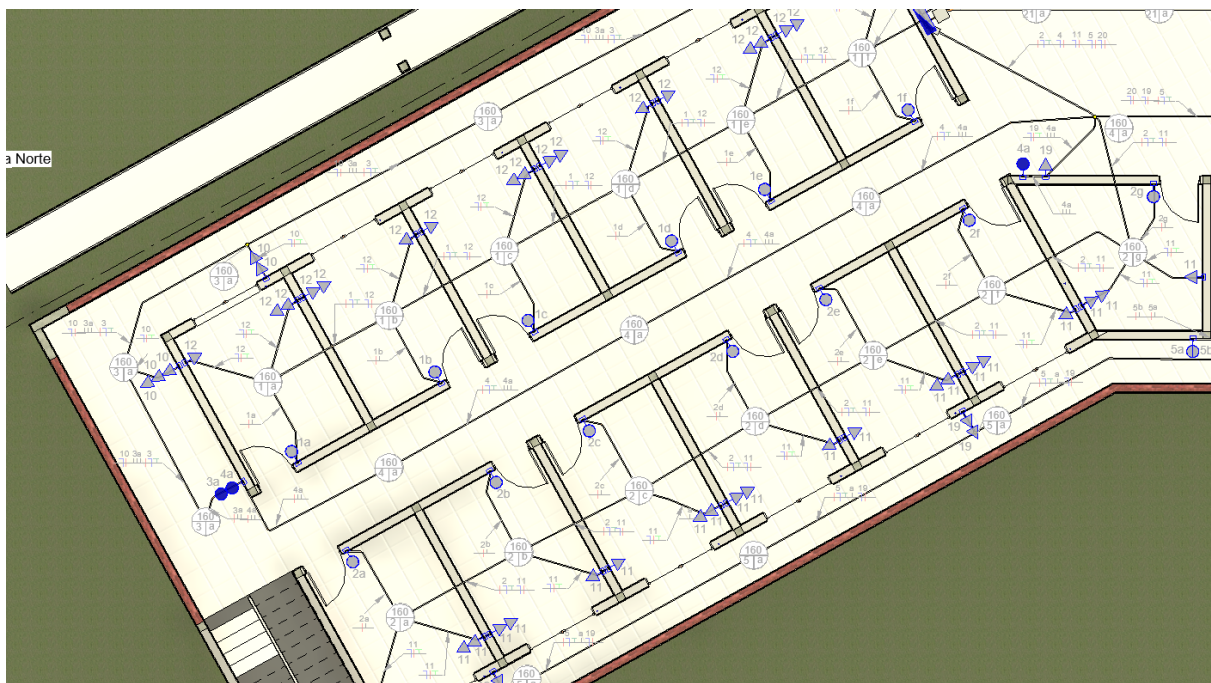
Vista Superior do Projeto elétrico no Primeiro Pavimento
